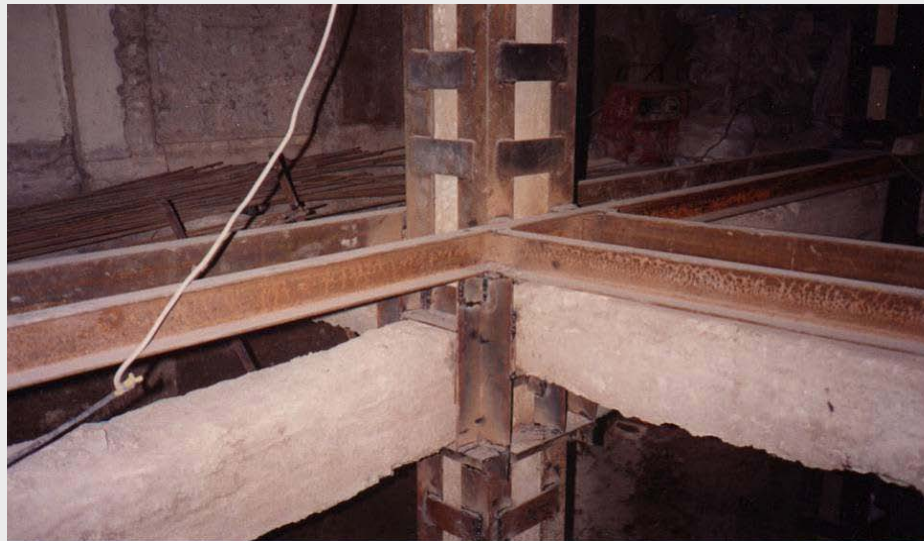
Verstärkung der Stahlbetonstütze und eines Balkens
